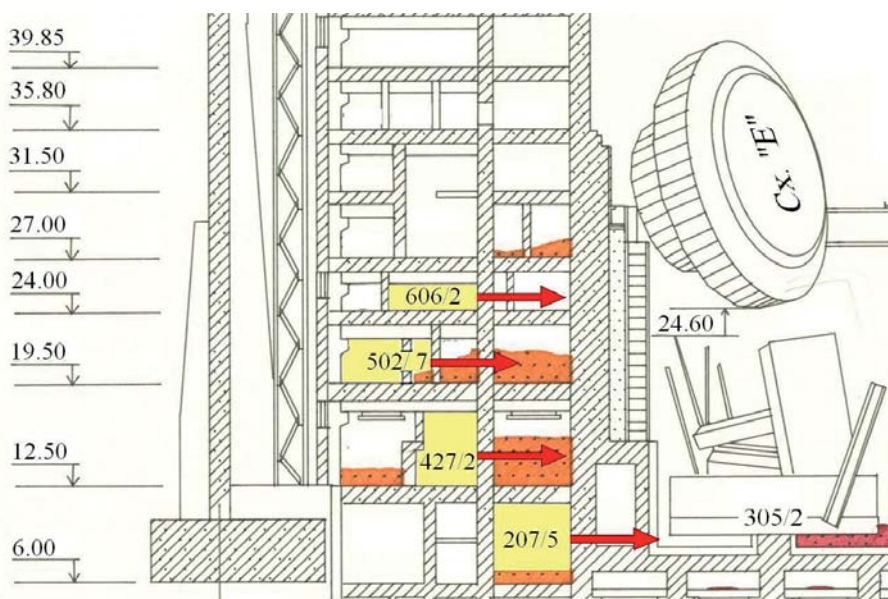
На схеме желтым цветом выделены помещения с западной стороны «Укрытия», из которых проводилось бурение в шахту реактора, пом. 305/2, в опорную плиту. Коричневым цветом отмечены скопления бетона, попавшего в помещения при строительстве «Укрытия». Красные стрелки — направление бурения
